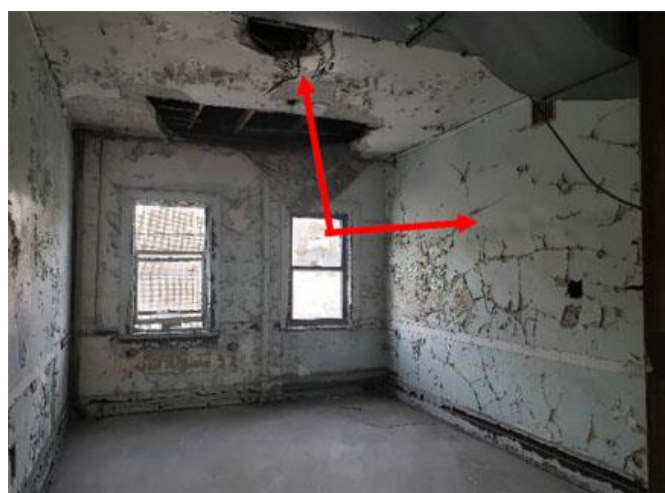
À l'étage, on retrouve une série de bureaux. Les murs et plafonds sont revêtus de plâtre. Source : STM.
